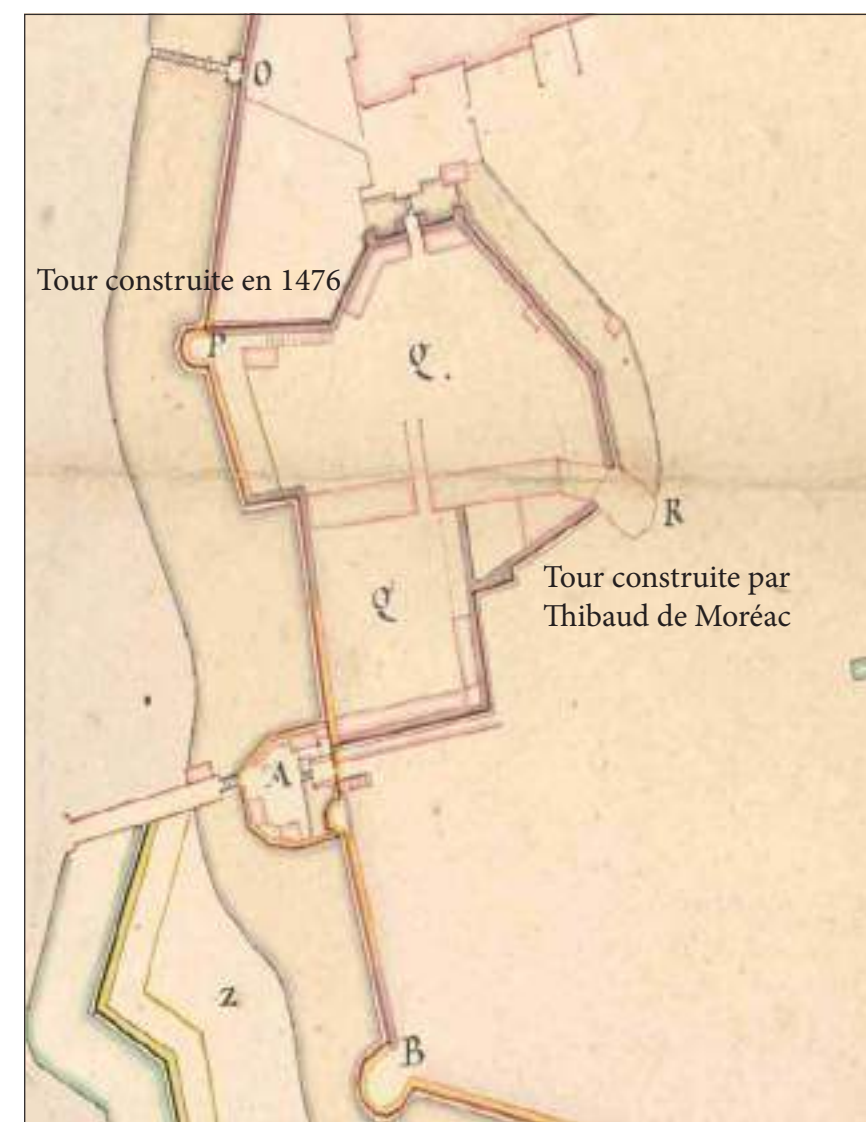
Plan du château de Dol, Picot, 1693 [AD 35, C 364]
